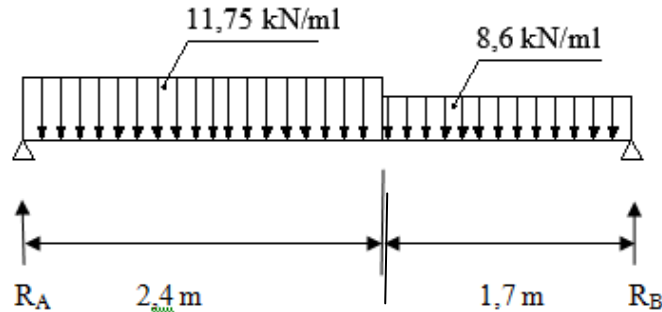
Schéma statique de chargement d'un escalier droit à l'ELS
